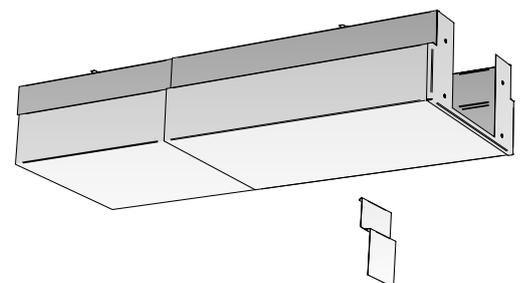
Anschlussabdeckung inkl. zusätzlichem Abdeckblech, um den Spalt zum Designgehäuse voll abzudecken.
